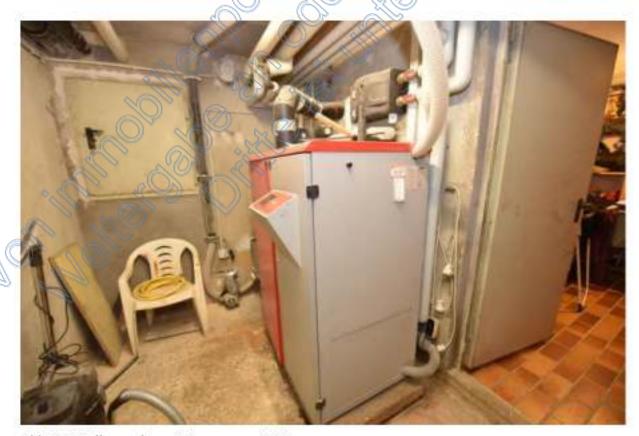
Kellergeschoss. Heizungsraum, Heizung
